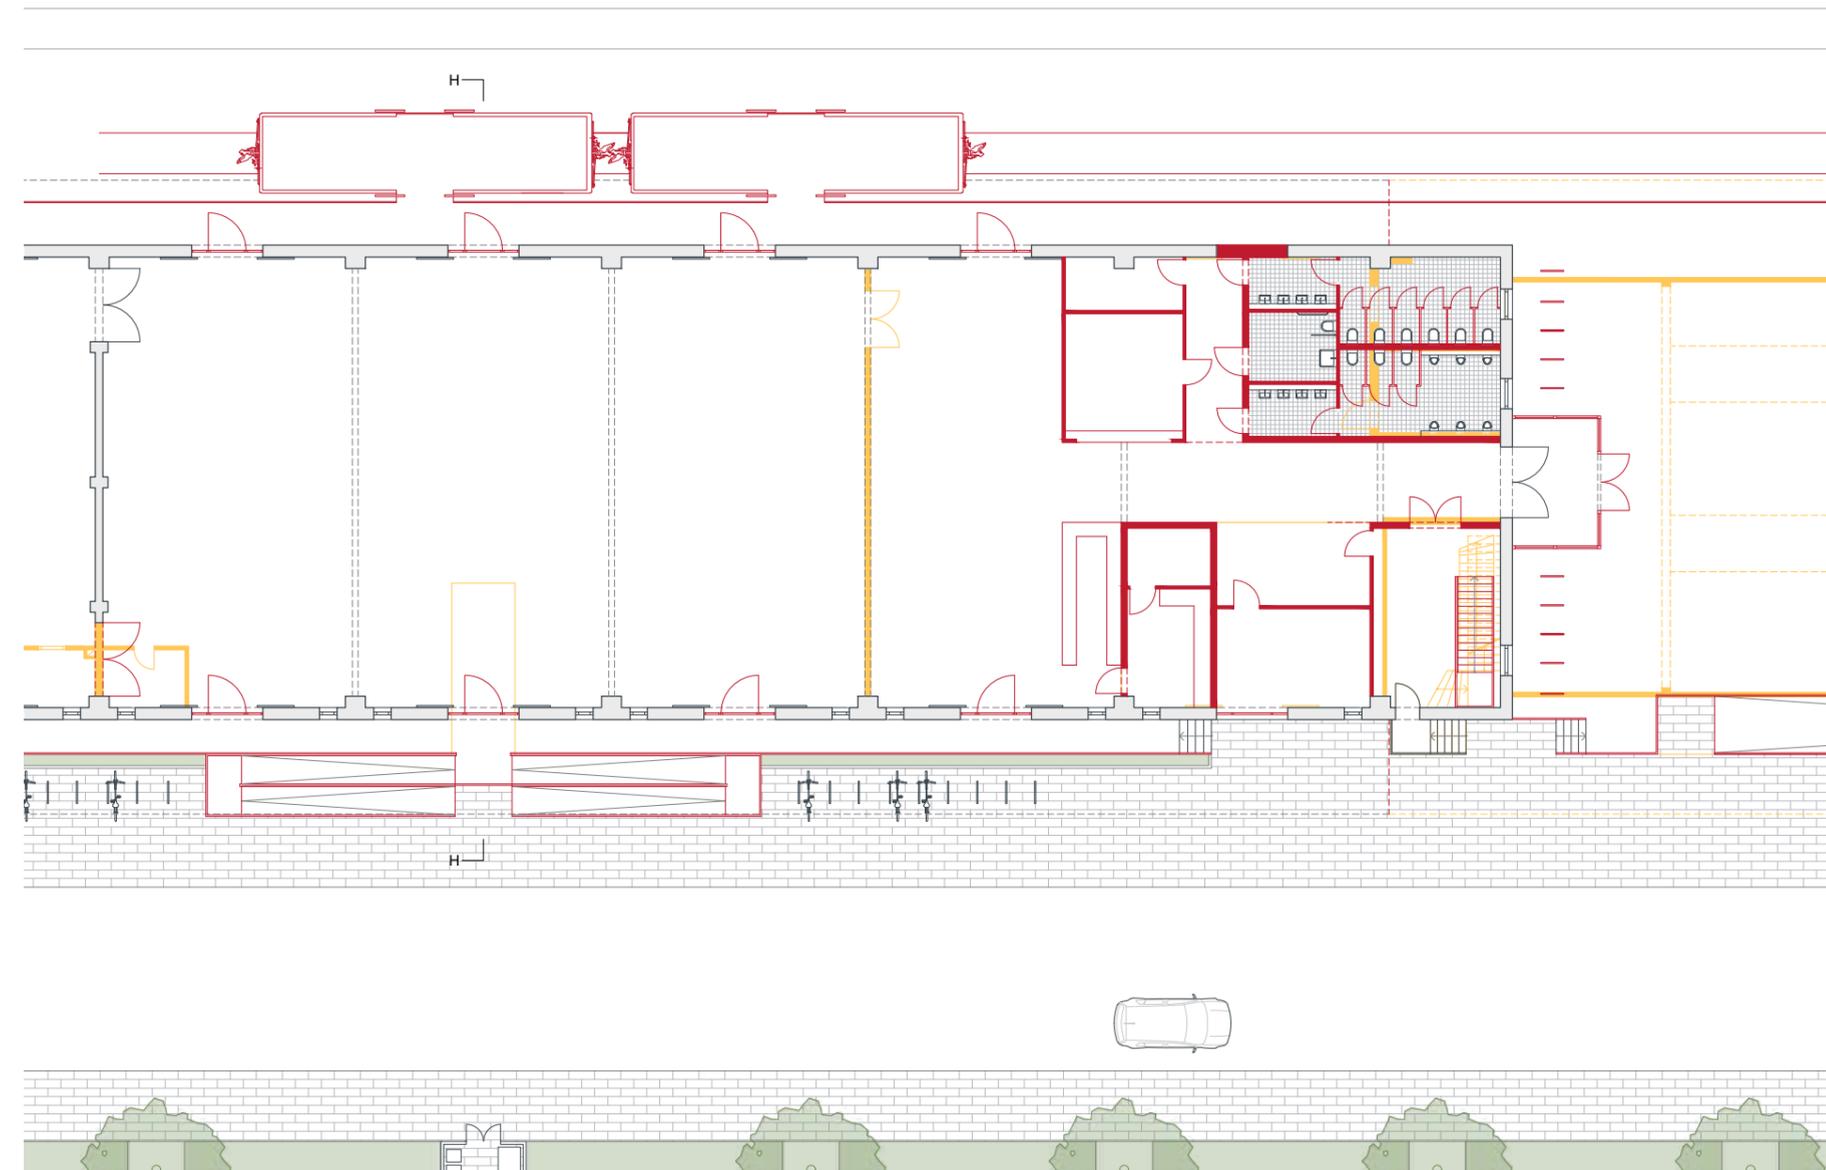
Stückgutschuppen: Bauliche Veränderungen, Veranstaltungshalle, Halle 3, Erdgeschoss M 1:250
